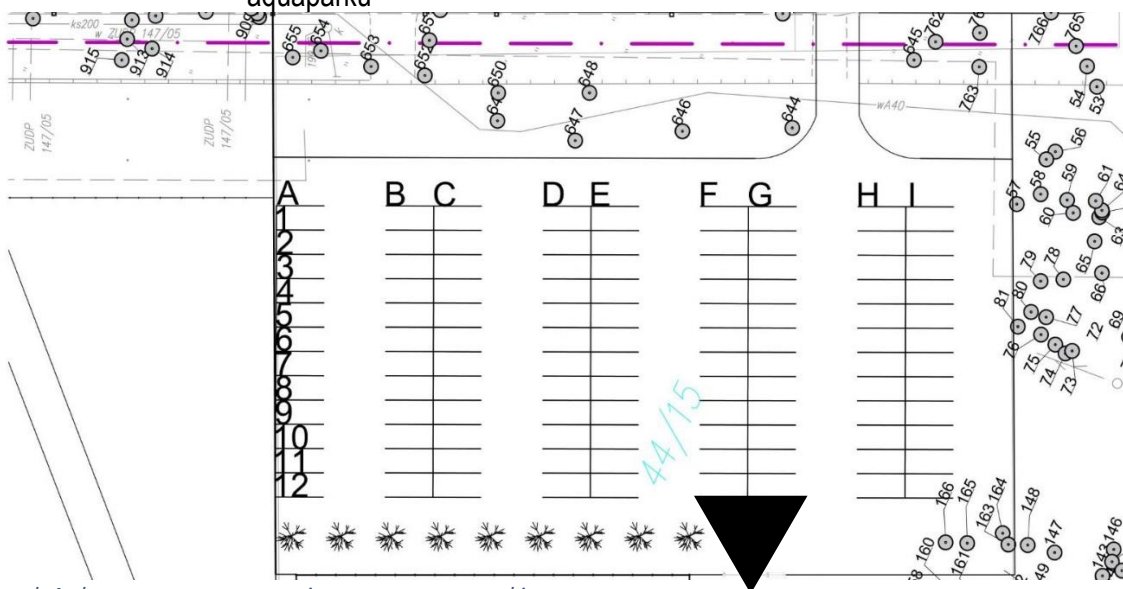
układ miejsc parkingowych na nowym parkingu
